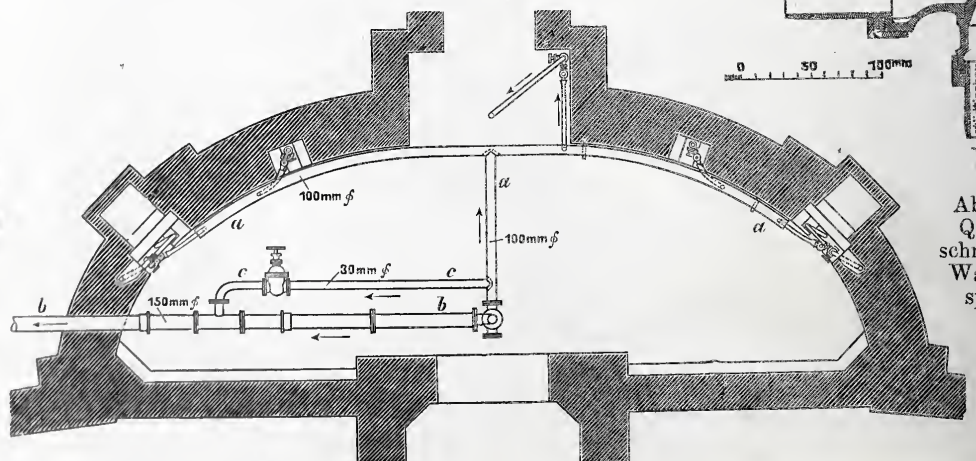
Rohrleitungen unter dem Wasserbecken. Grundriß.
